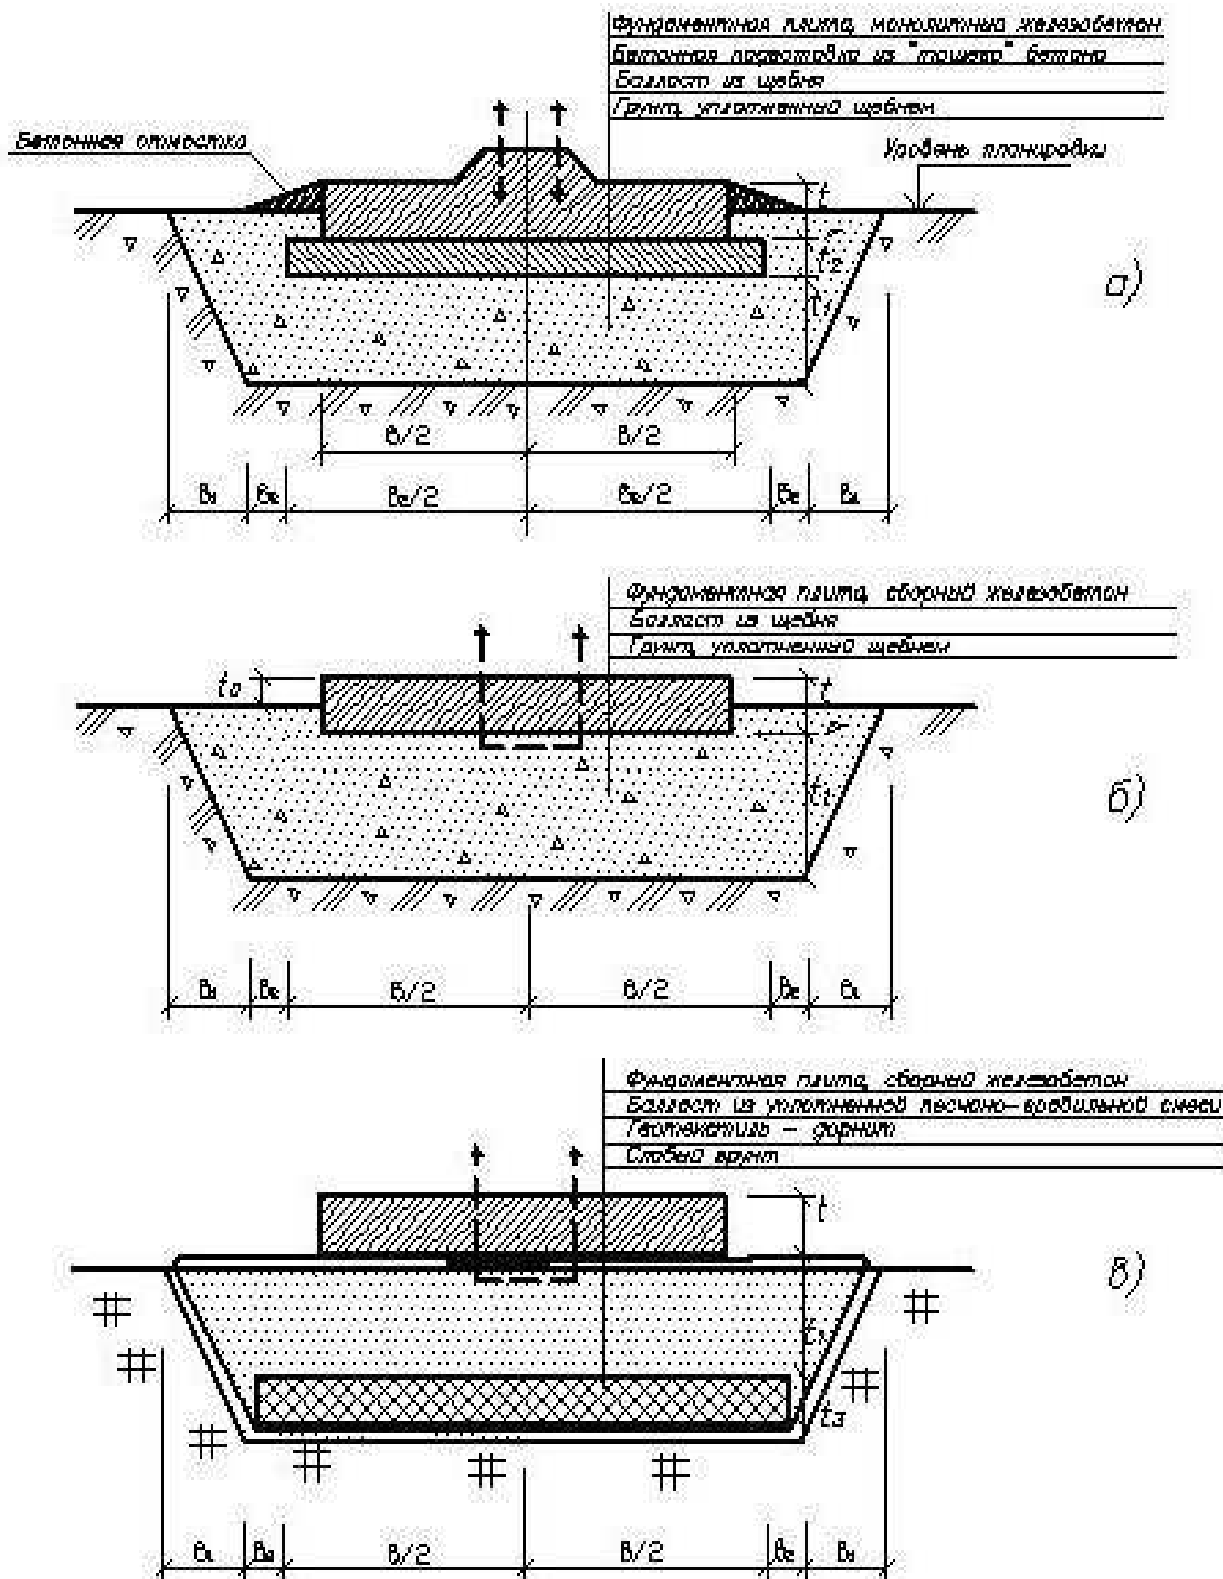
Конструктивные решения мелкозаглубленных и поверхностных фундаментов с врезной подушкой, устроенной в вытрамбованном котловане:
